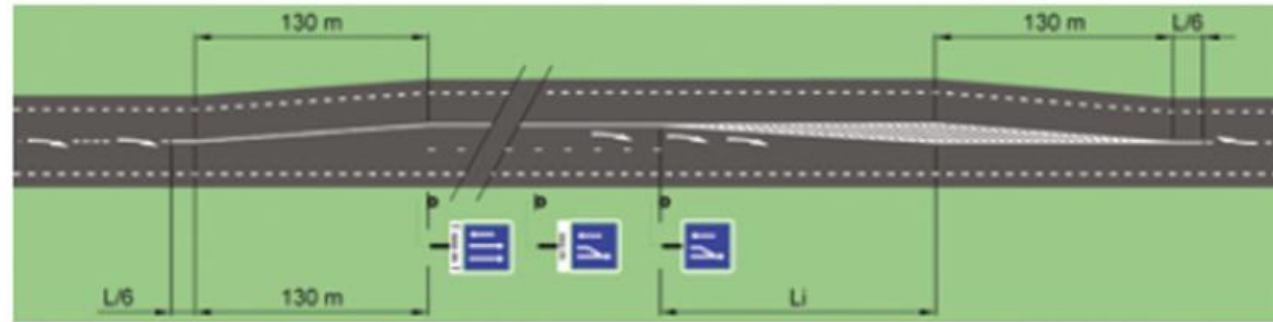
Schéma de construction d'un créneau de dépassement – ARP 2022
